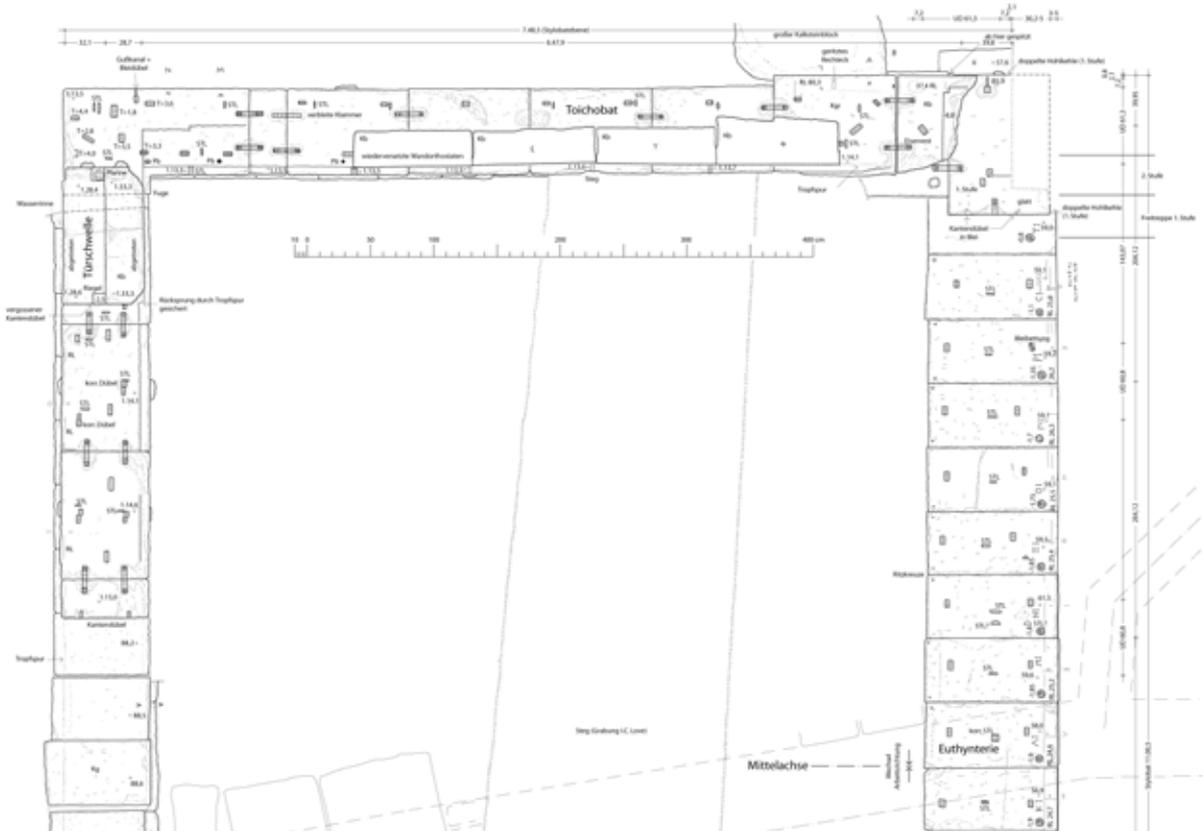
Propylon. Grundriss der nördlichen Hälfte. Kleine Versatzmarken auf der Euthynterie am Bildrand vergrößert dargestellt.
